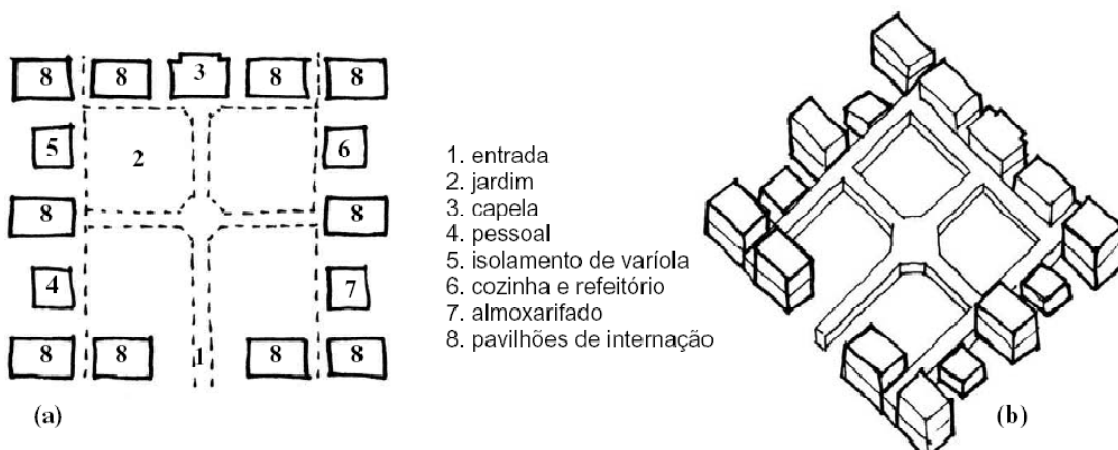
Royal Naval Hospital, Inglaterra, 1756-1764. (a) planta; (b) croqui.
